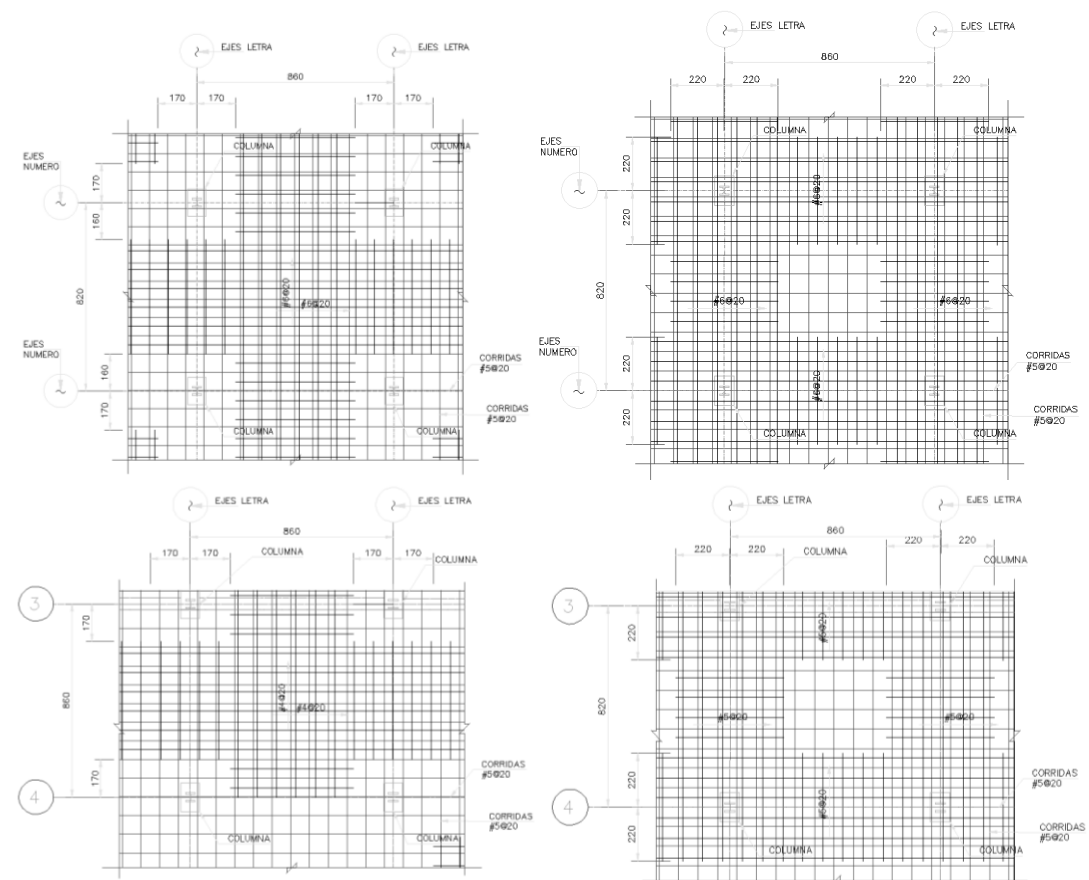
Detalle de armado de acero en losas de planta baja. Colinas de Buen S.A de C.V. (2016).
